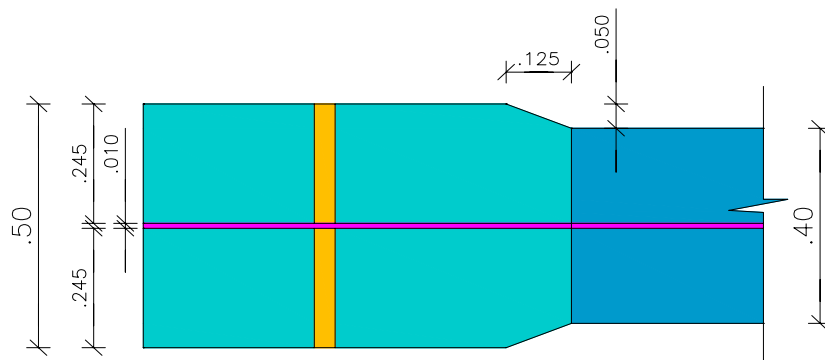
Configuración en Planta de los rigidizadores de apoyo
